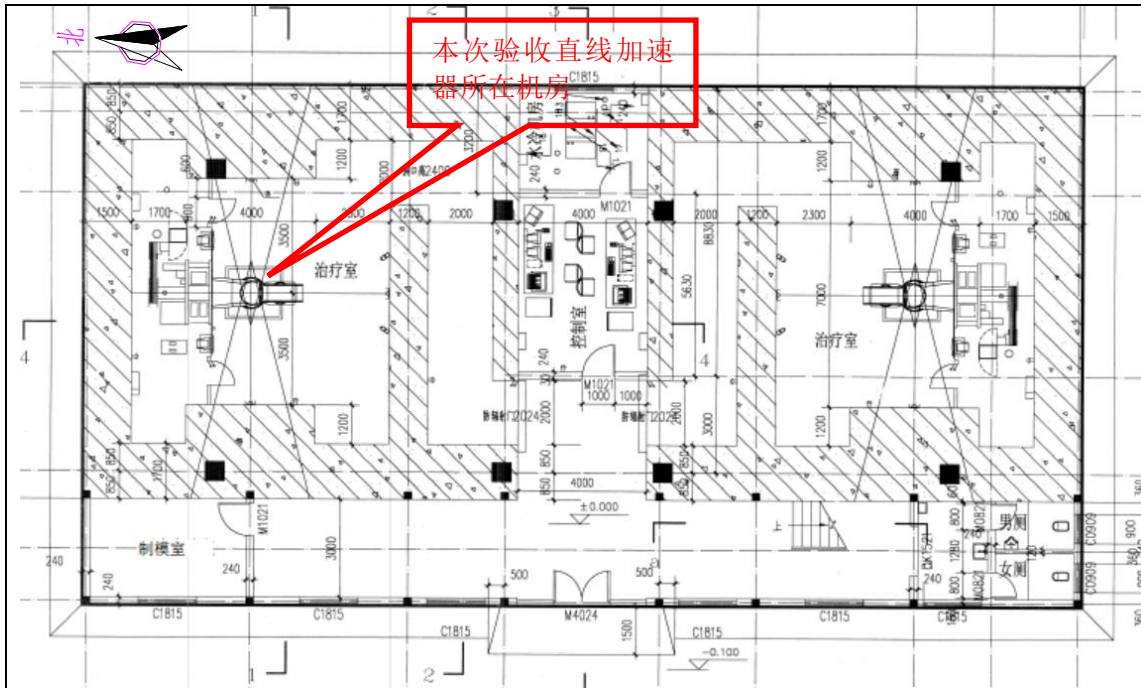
全椒县人民医院放疗中心一楼平面布置图
